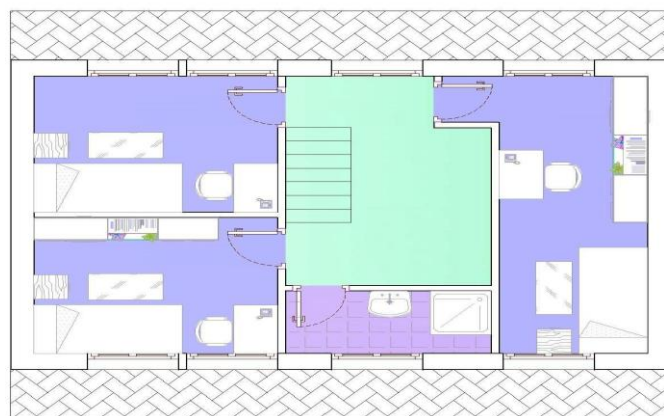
plan du 1^{er} ETAGE réalisé avec Autocad.
